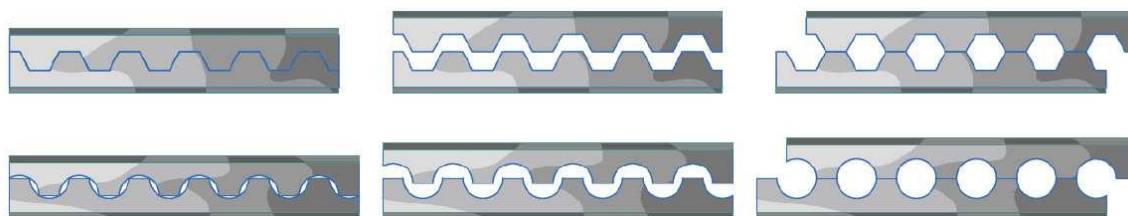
Esquema de fabricação de vigas casteladas e celulares (TEIXEIRA, 2017).
